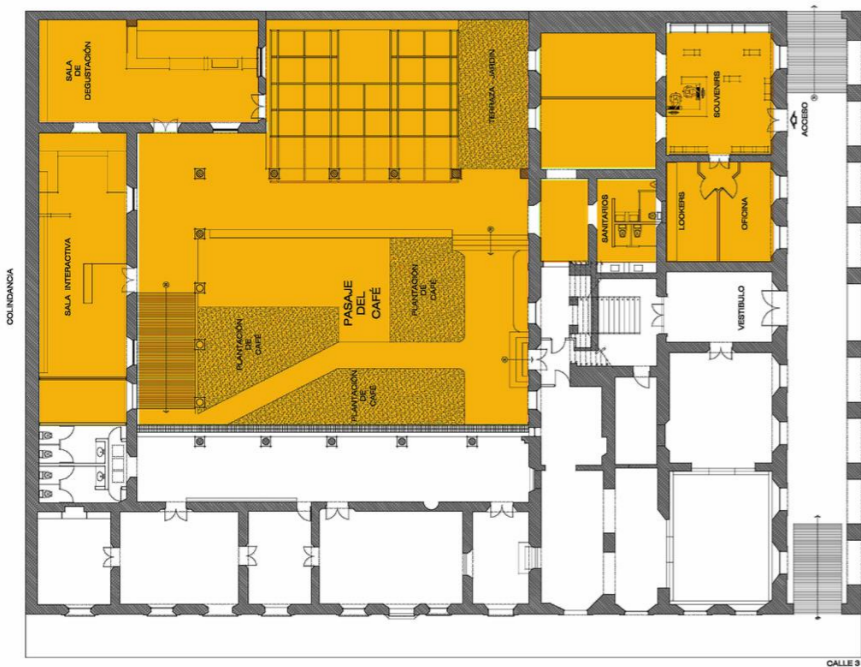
Planta arquitectónica de área intervenida, fuente: Archdaily.mx
